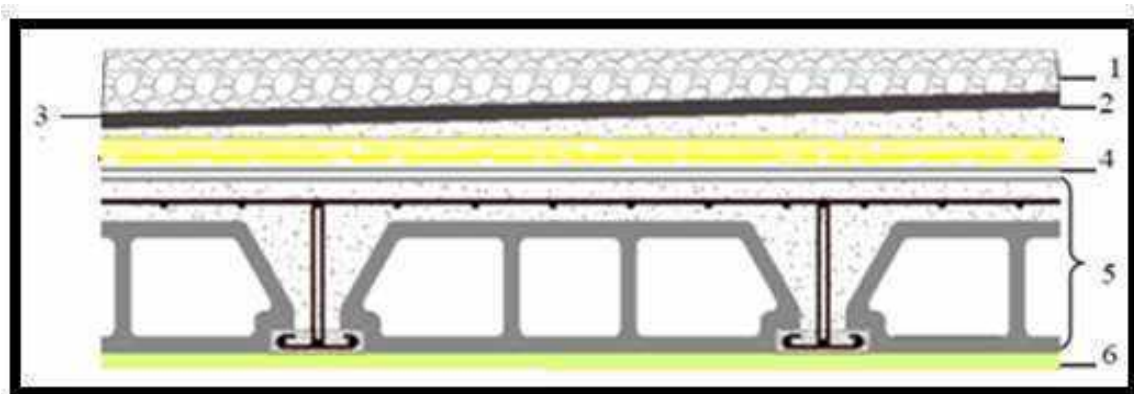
Composants d'un plancher terrasse en corps creux.
